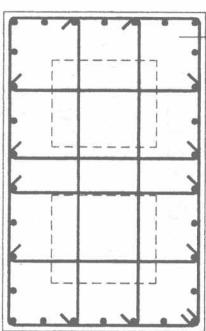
双高杯口独立基础杯壁配筋示意
